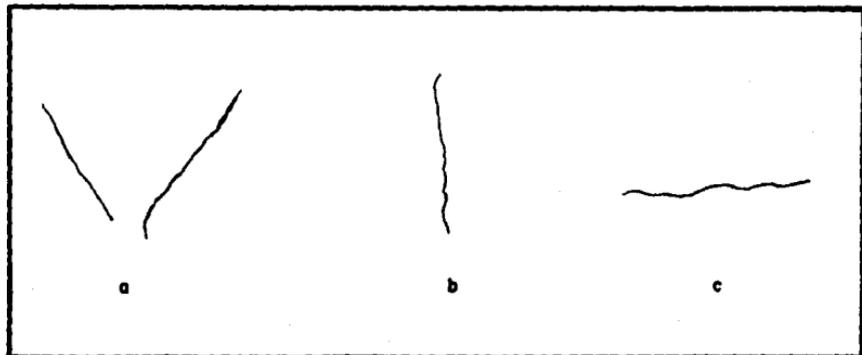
Croquis de fallas más comunes en los elementos estructurales.
